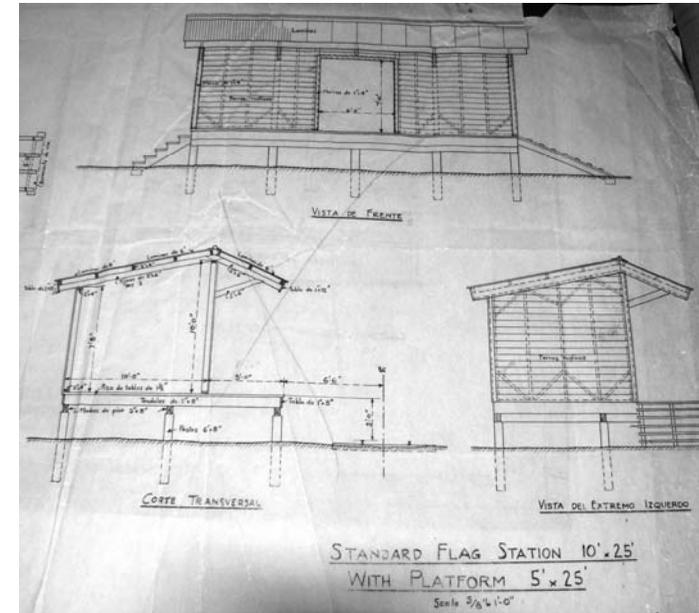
Plano de estación de bandera típica –elevación y sección- encontrado en archivo de FEGUA.
